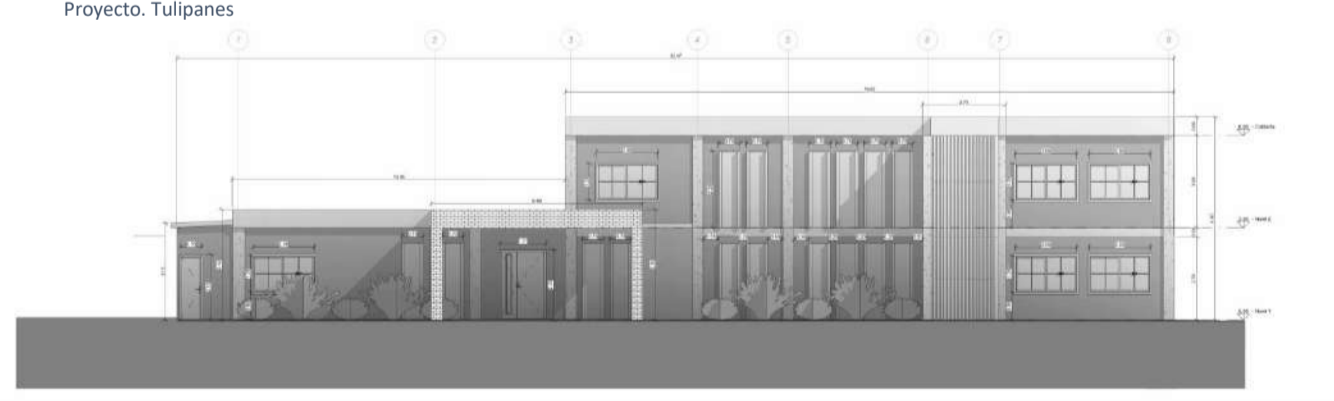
Elaboración propia Fuente. Fachada Frontal Proyecto. Tulpanes
